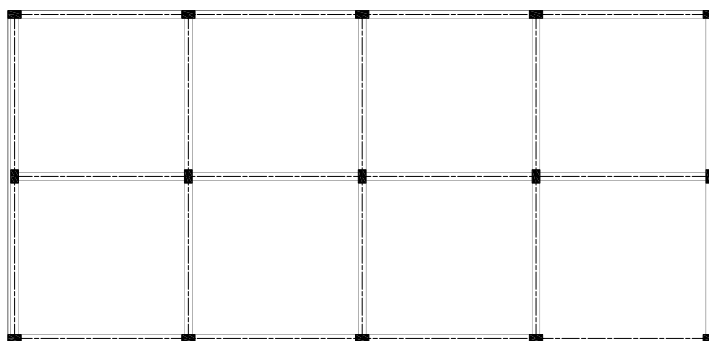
Interrupción del arriostramiento por supresión de viga
